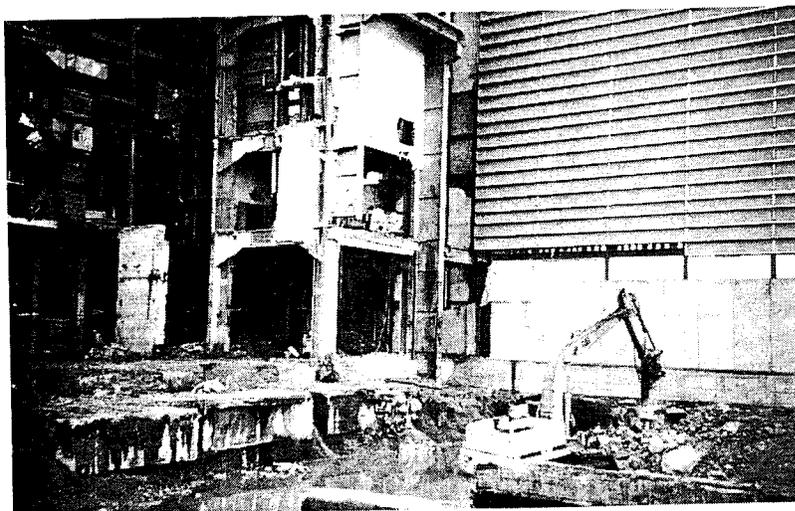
Abbruch und Fundamentfreilegung alter Bausubstanz.
